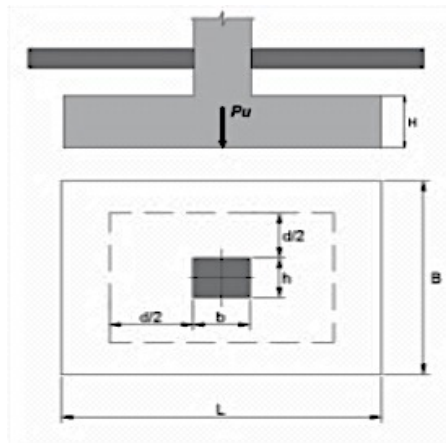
Predimensionamiento de las zapatas de la vivienda. Fuente: "Diseño de Concreto Reforzado Jack C. McCormac"
